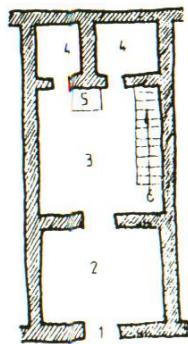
مسقط مع تصور لمسكن من جارمو - العراق ٦٠٠ ق.م
